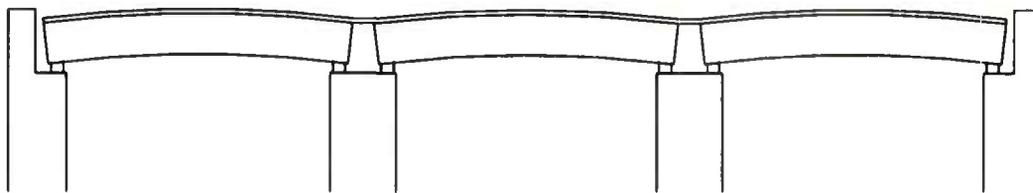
Imperfections du profil en long, dans le cas d'une succession longitudinale de poutres précontraintes indépendantes (déformations amplifiées).
